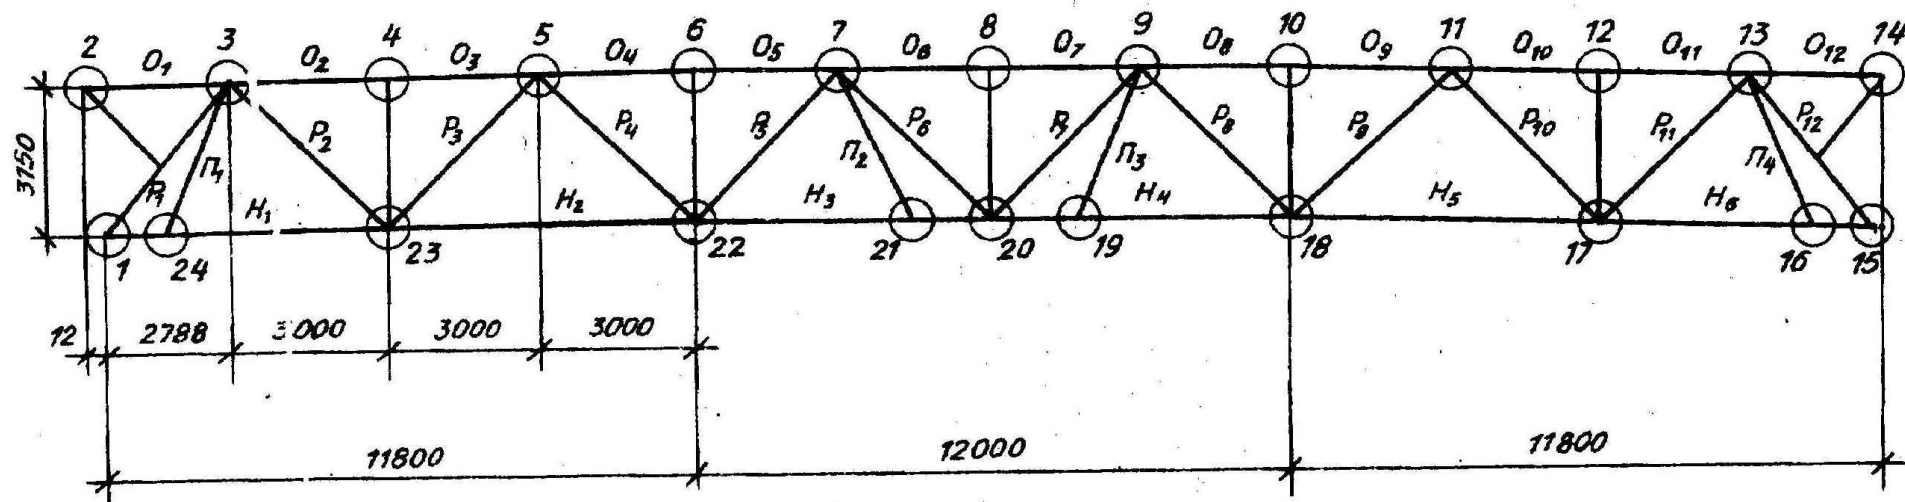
Геометрическая схема фермы V ФС-36 – 1, 85 В
